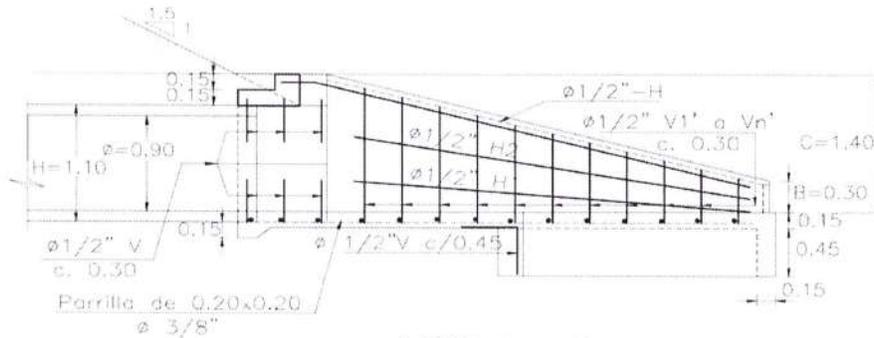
Sección típica longitudinal de alcantarilla circular de 36" en Tramo Vial Mariangola – Villa Germania.
